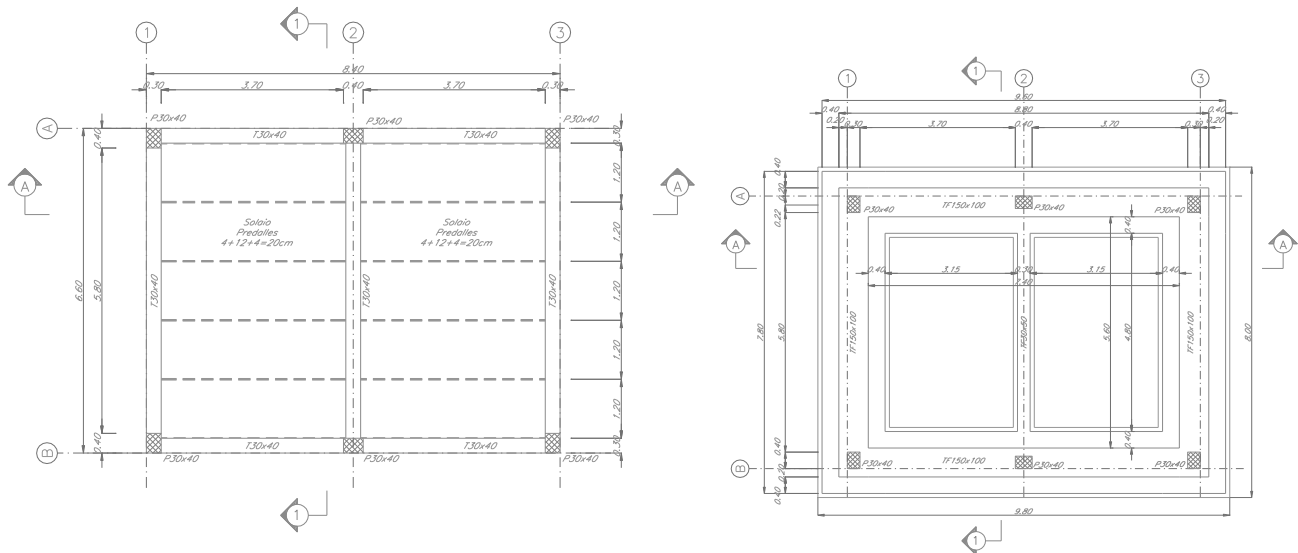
Pianta solaio e pianta fondazioni locale consegne al km 5+467,211
